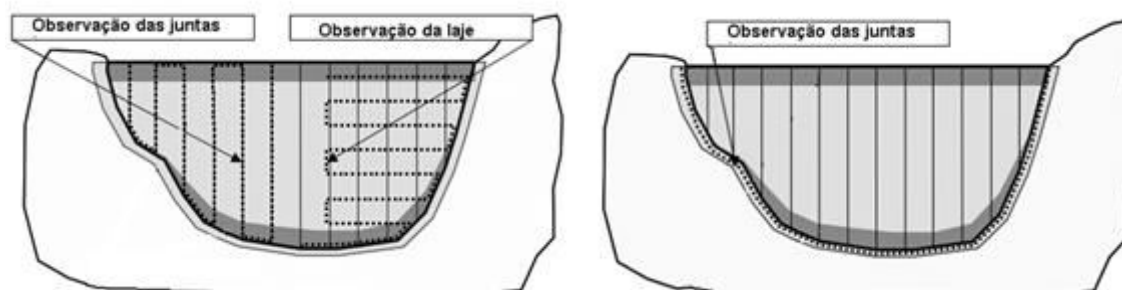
OBSERVAÇÃO DA LAJE E JUNTAS
